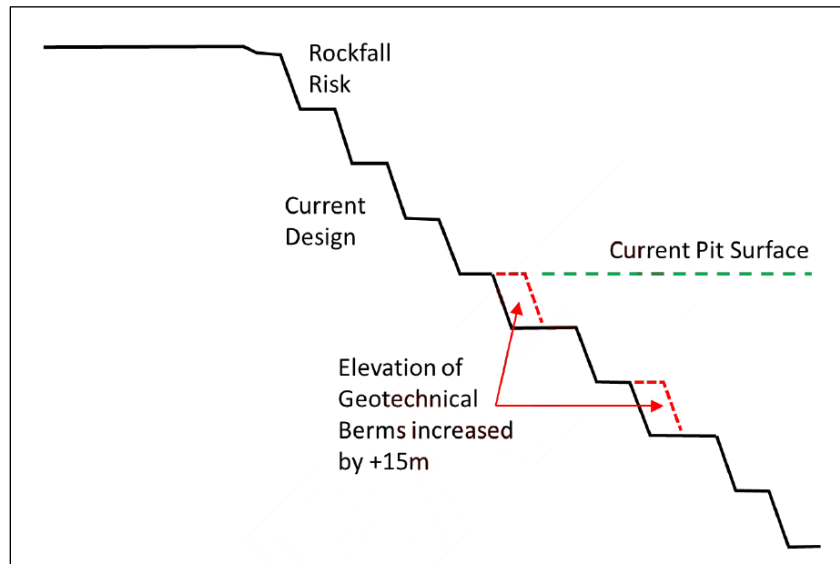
Propuesta de reconfiguración de la pared suroeste recomendada por la firma geotécnica Piteau Associates.
